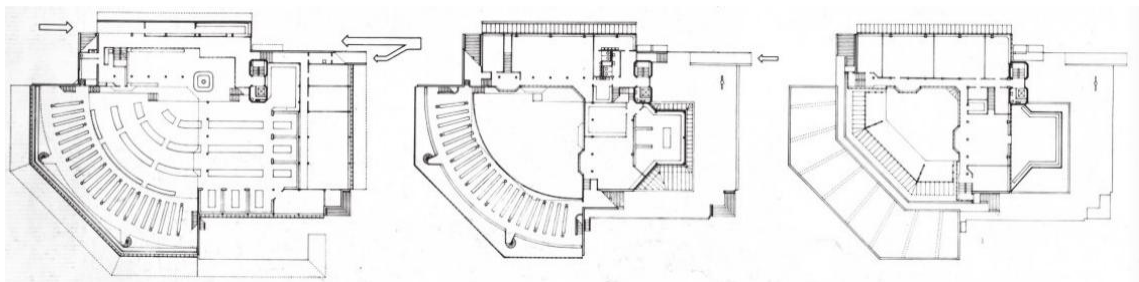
Planta térrea da Biblioteca da Faculdade de História
